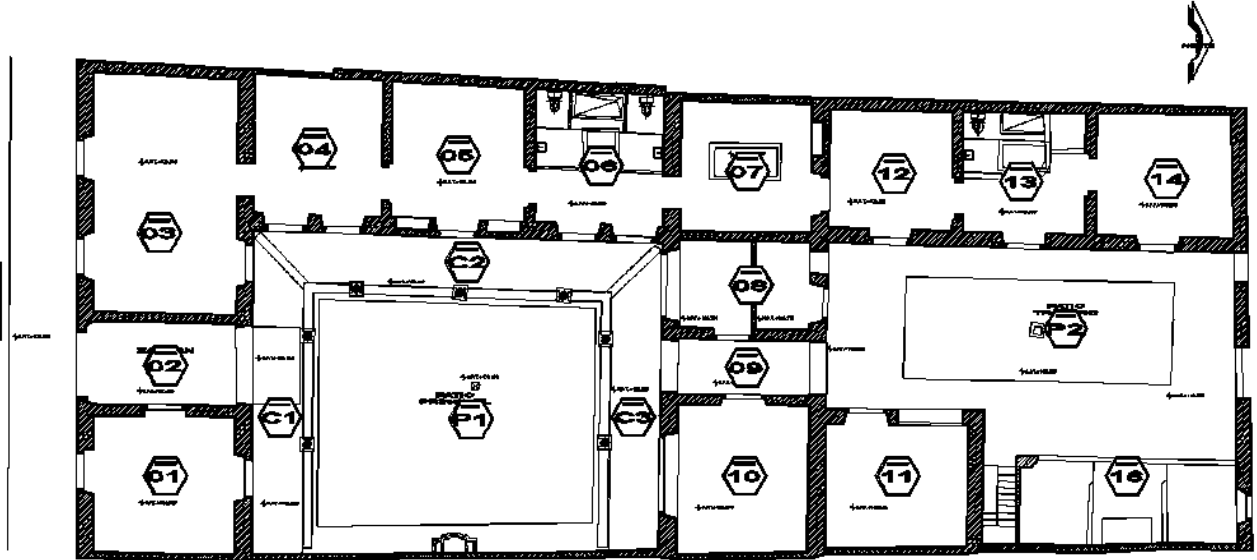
Planta arquitectónica Elaboró: Alelí Cortés Vargas
